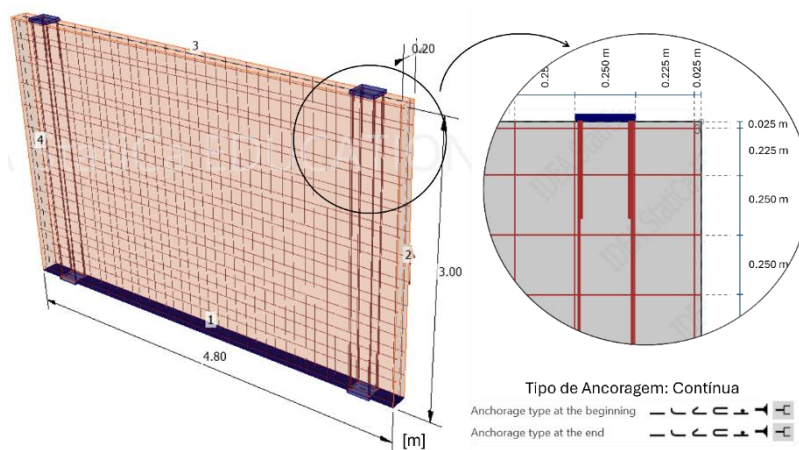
Modelação numérica das armaduras numa parede sem aberturas no *IDEA StatiCa Detail*.
